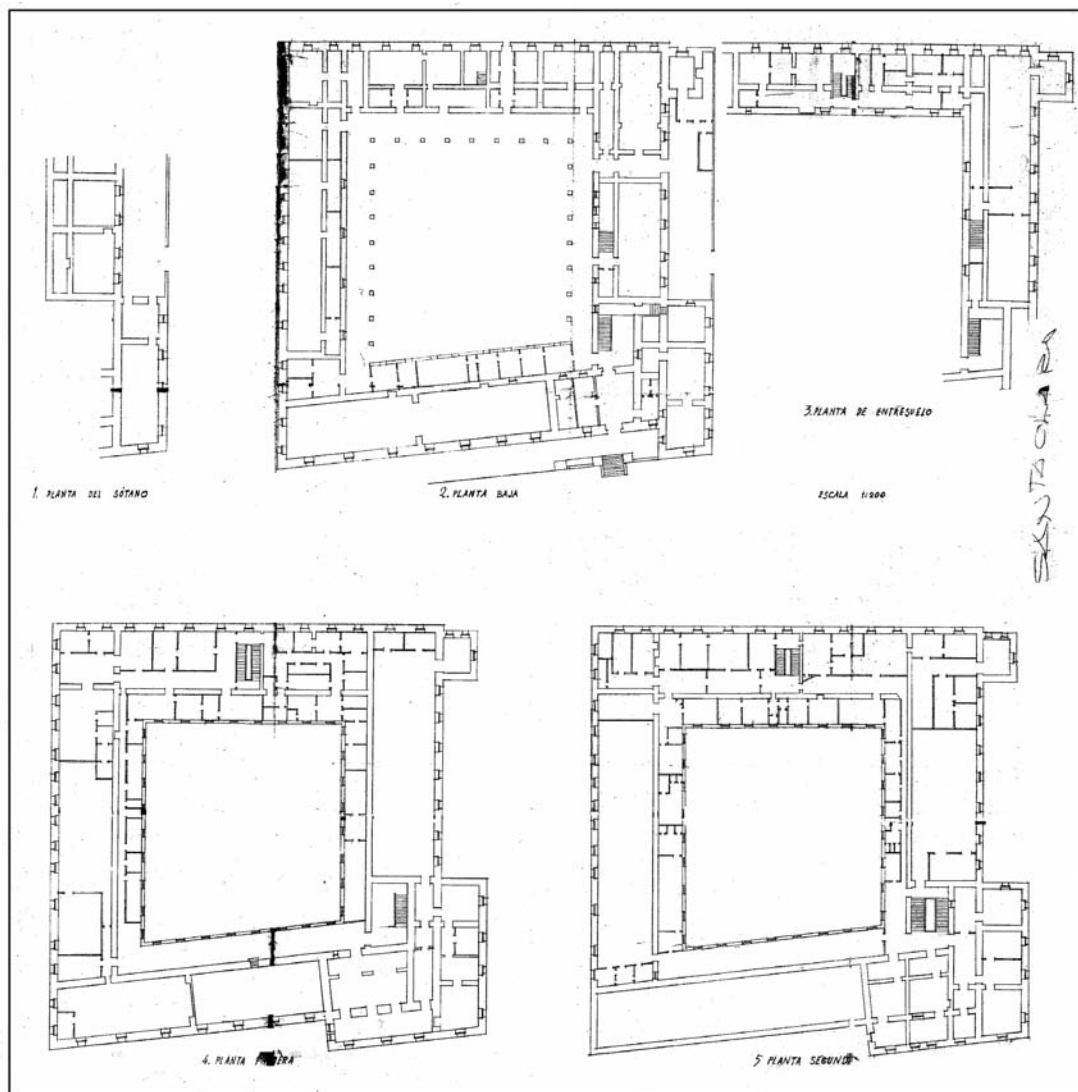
Plantas de estado previo para la intervención del arquitecto Ignacio Álvarez Castelao en el antiguo Convento de Santa Clara (Archivo particular de la familia Álvarez Castelao).
